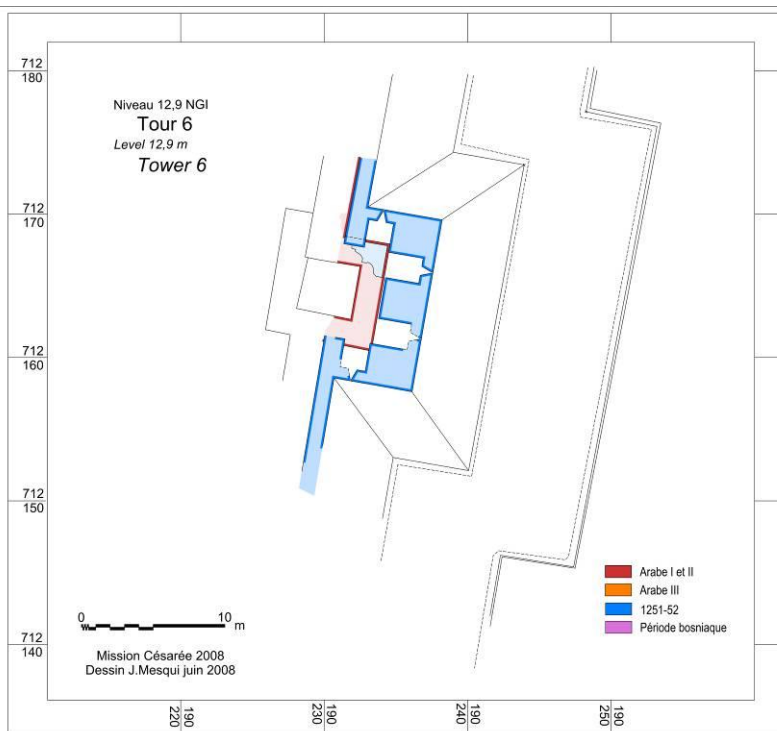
Plan de la tour au niveau 12,9 m ASL
